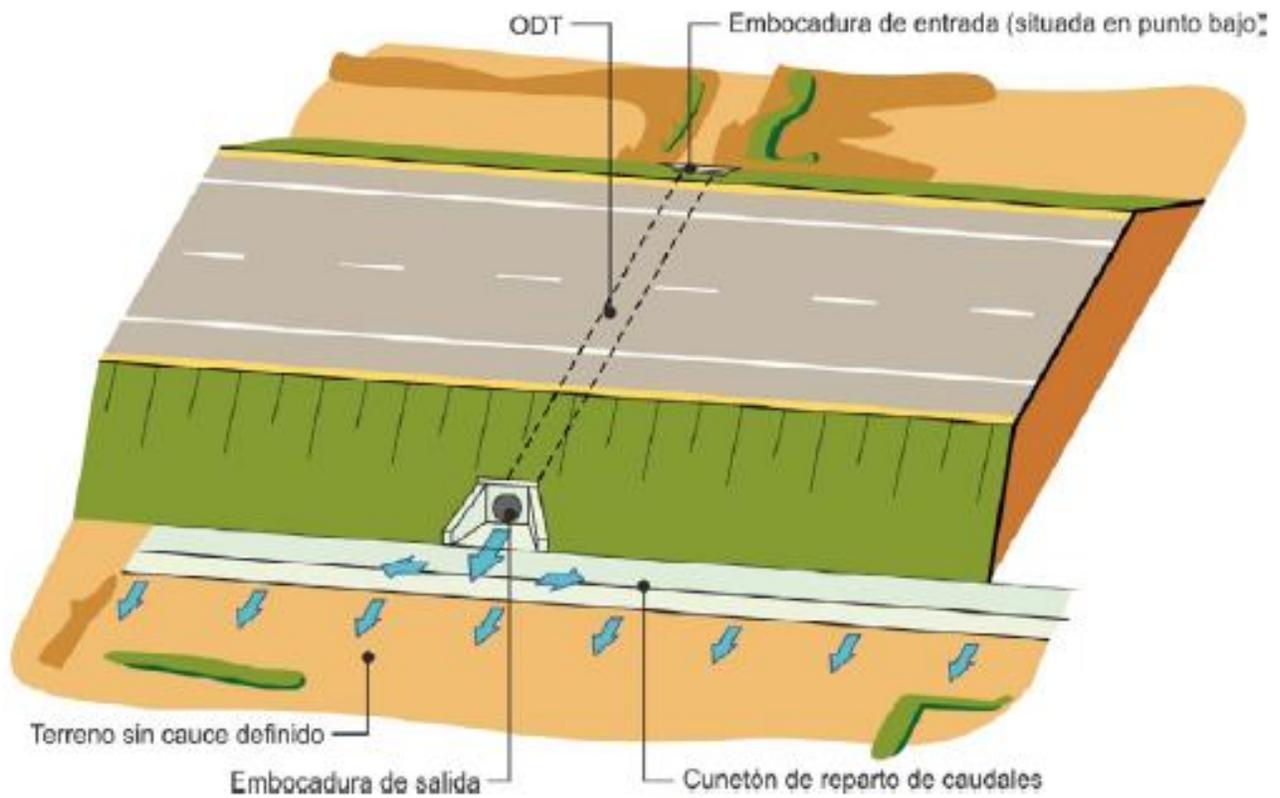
PROPUESTA DE CANAL TRAPEZOIDAL
